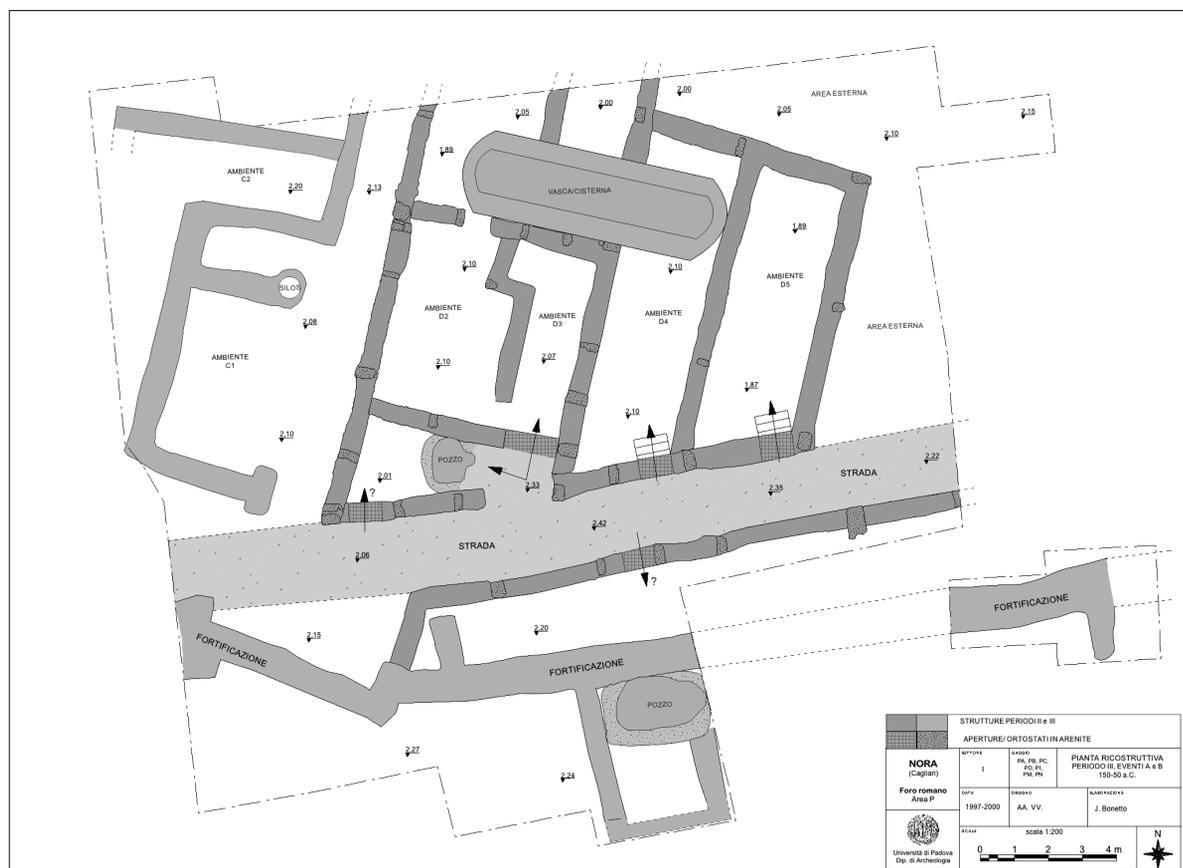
Planimetria delle strutture sotto il foro nel I s. a.C. (Bonetto 2009: 156).
